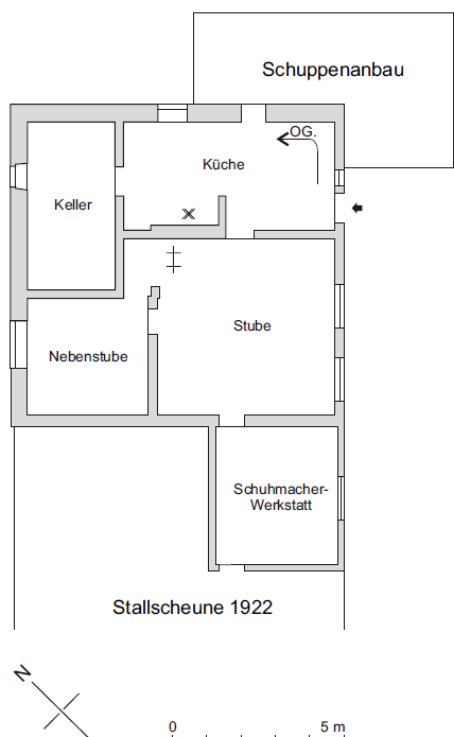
Erdgeschoss, Grundriss 1:200.
